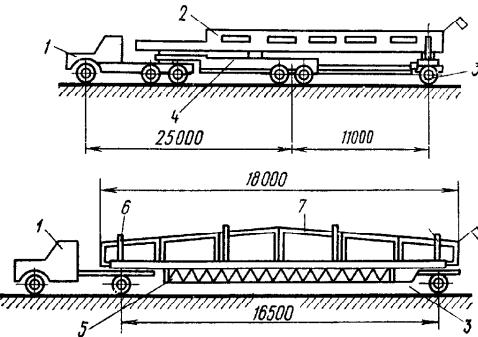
Перевозка железобетонных конструкций в положении на ребро;
